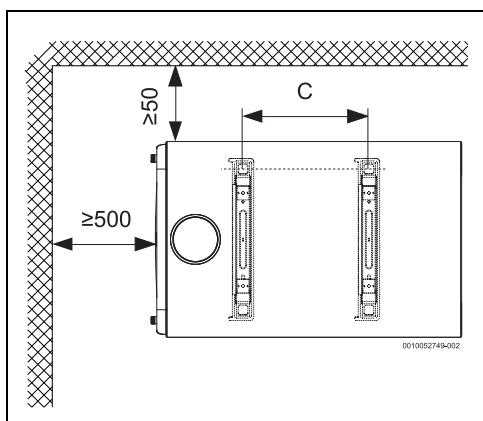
Dimensões em mm (montagem mural, instalação horizontal)
